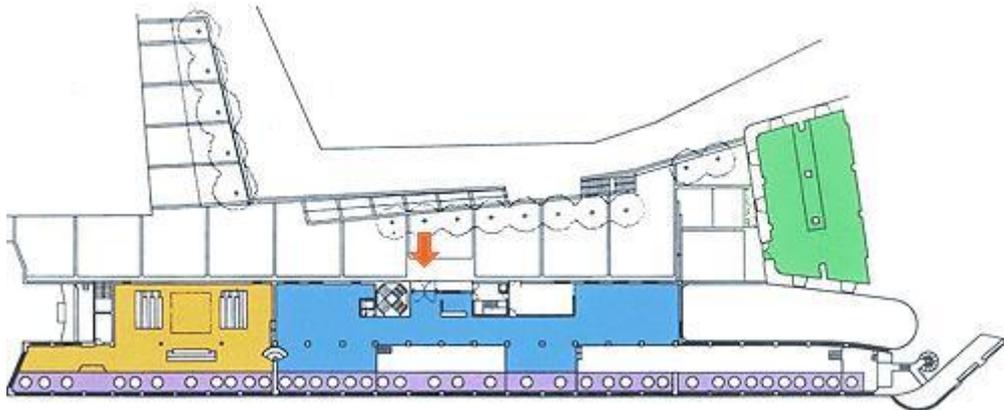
Plano planta de un edificio singular. (Fuente: Los autores)
